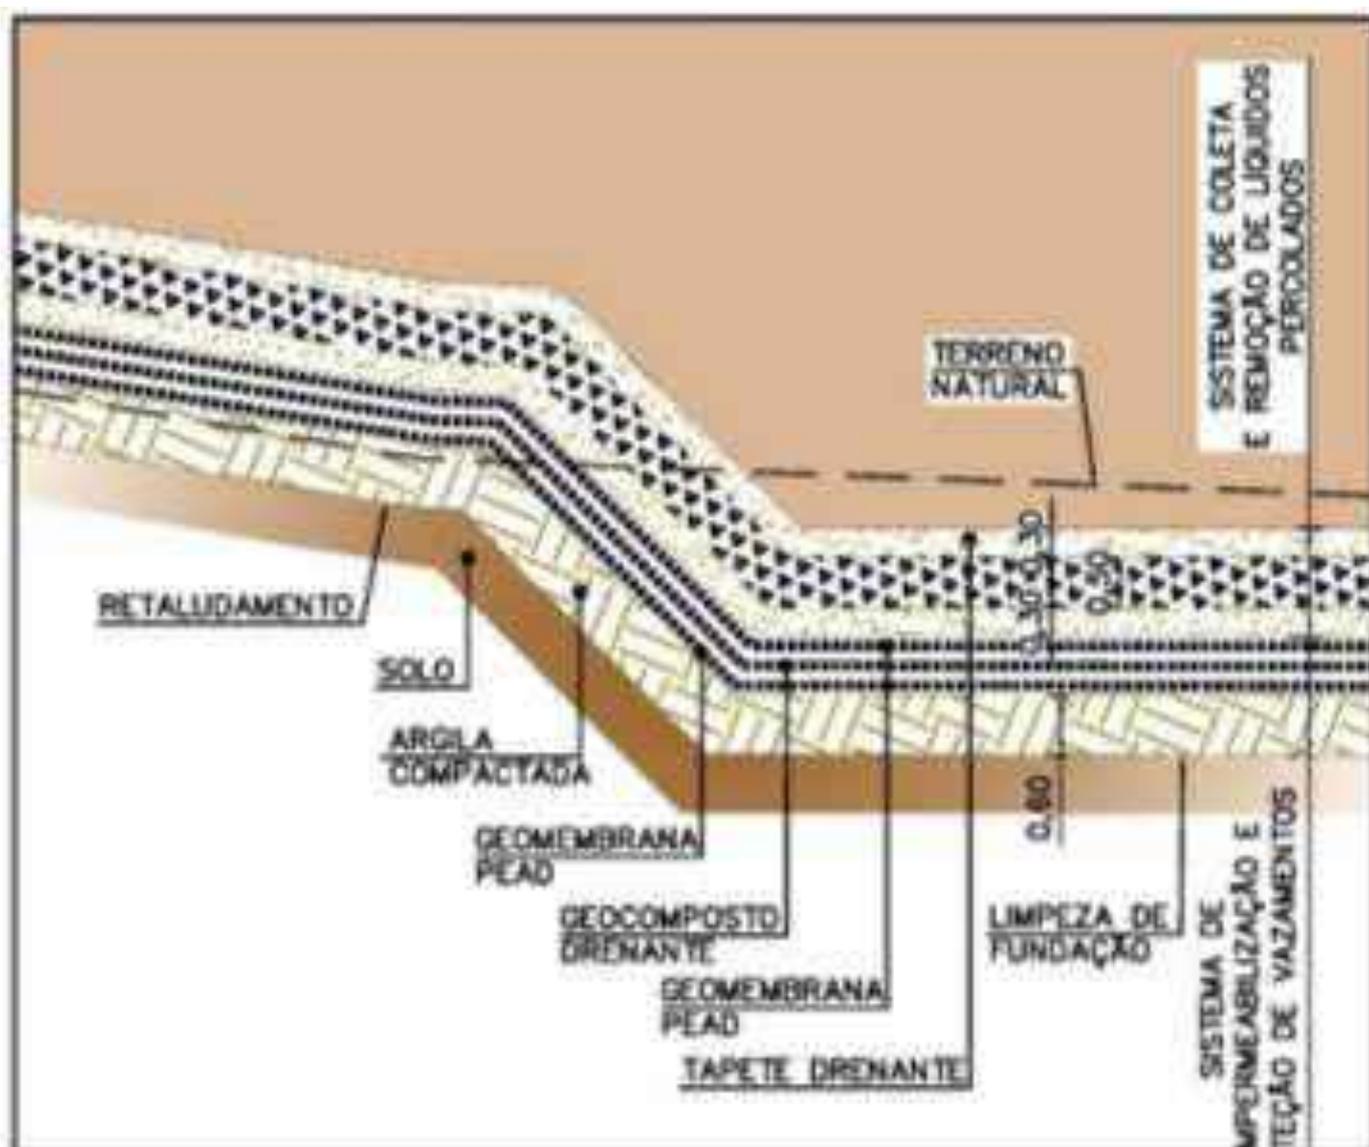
Detalhe típico do sistema de impermeabilização e de detecção de vazamentos
